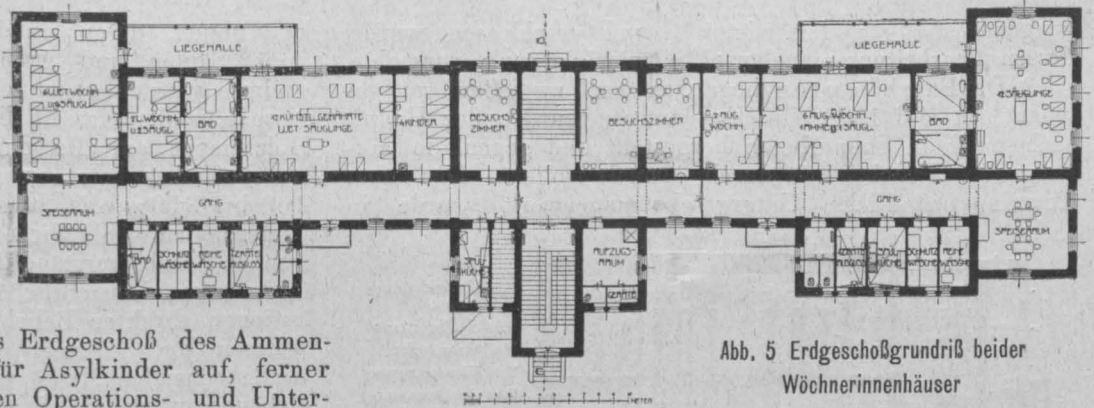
Erdgeschoßgrundriß beider Wöchnerinnenhäuser
